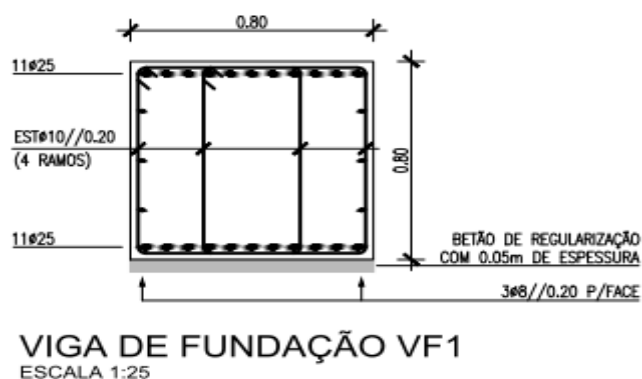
Viga de Fundação. [Fonte: Projeto de estruturas]
